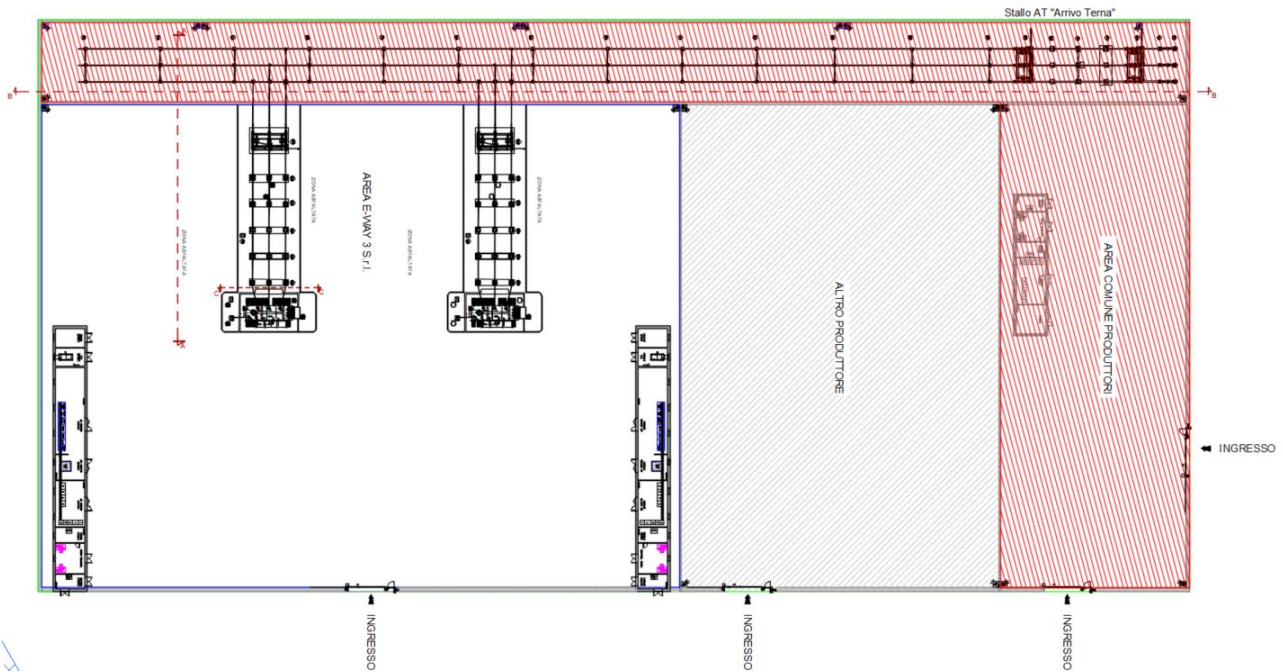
Planimetria Stazione di Trasformazione Utente 150/30 kV e Area Comune
